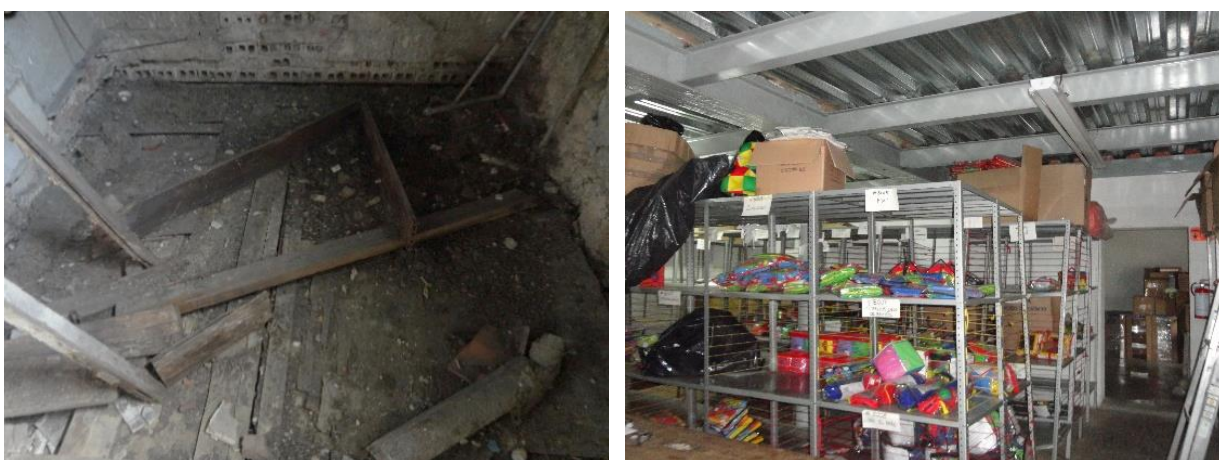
Daños en uno de los locales de planta alta y vista del tapanco.
